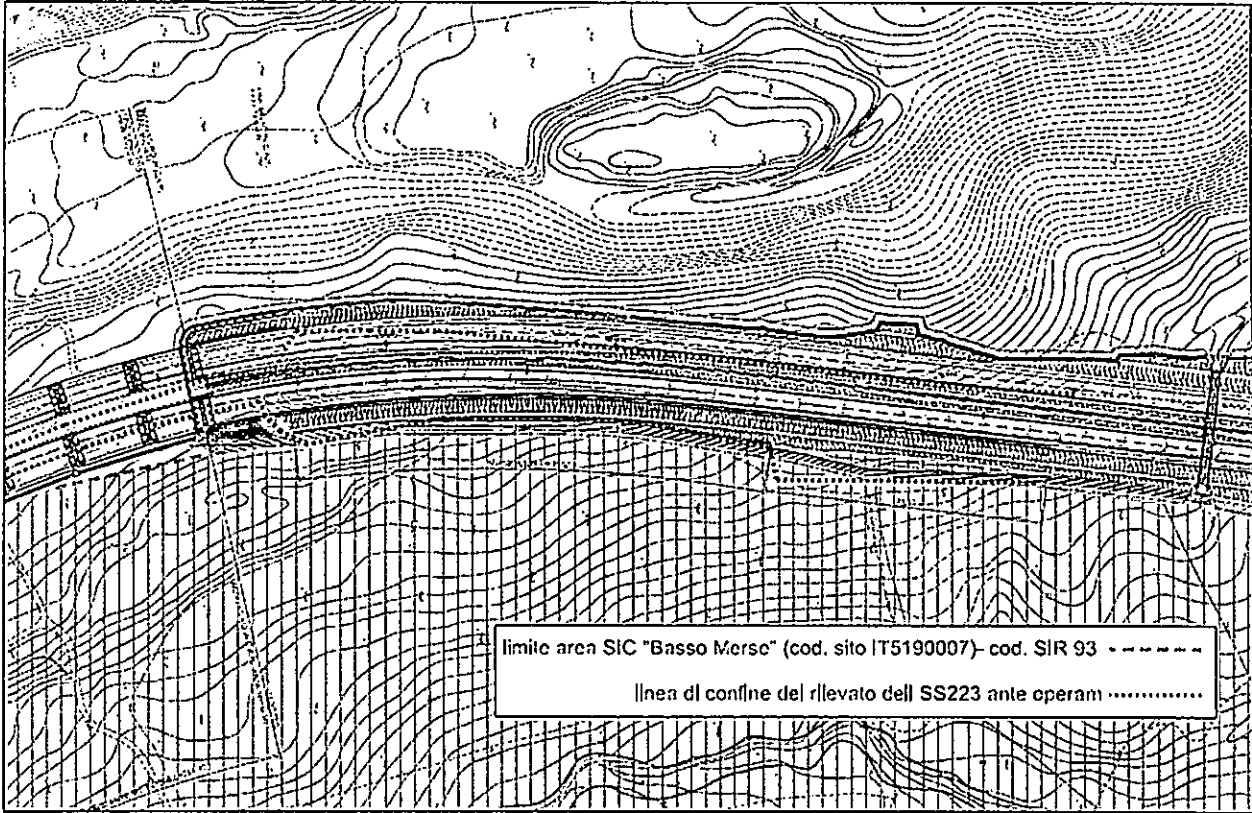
Stralcio planimetrico – Sistemazione carreggiata destra – Progetto Esecutivo TR24
